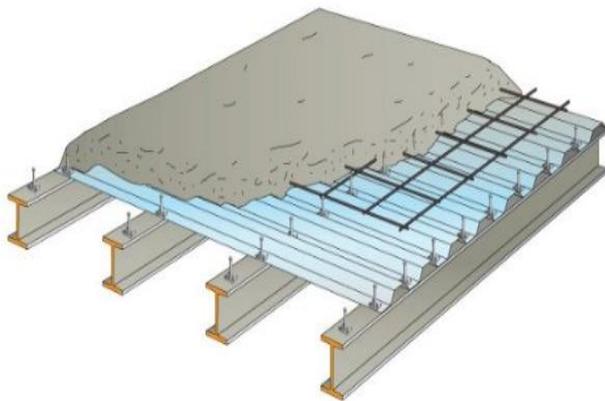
Plancher mixte acier-béton de type bac acier connecteurs.
